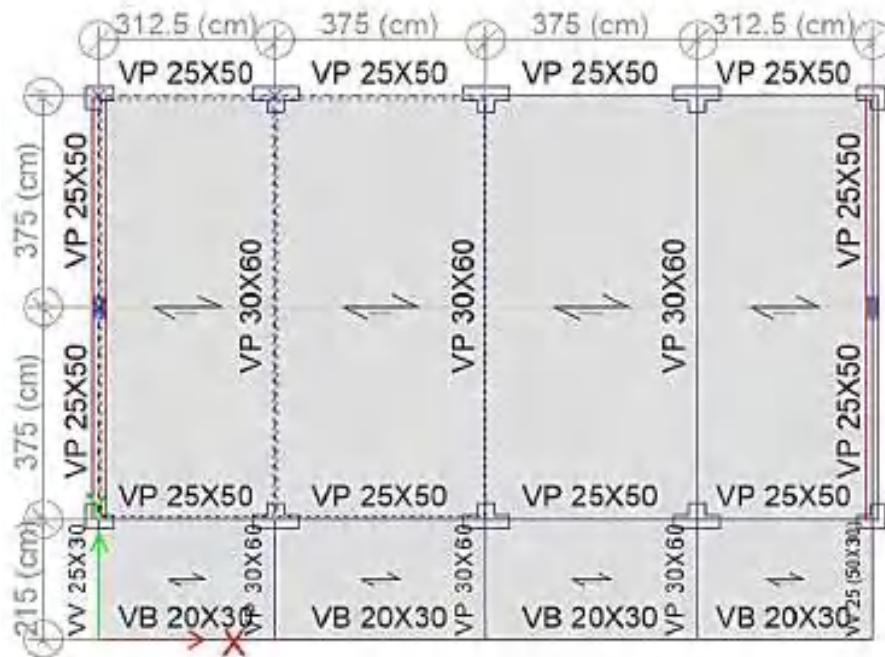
Elementos estructurales Bloque IV – Taller creativo (Primer piso).
